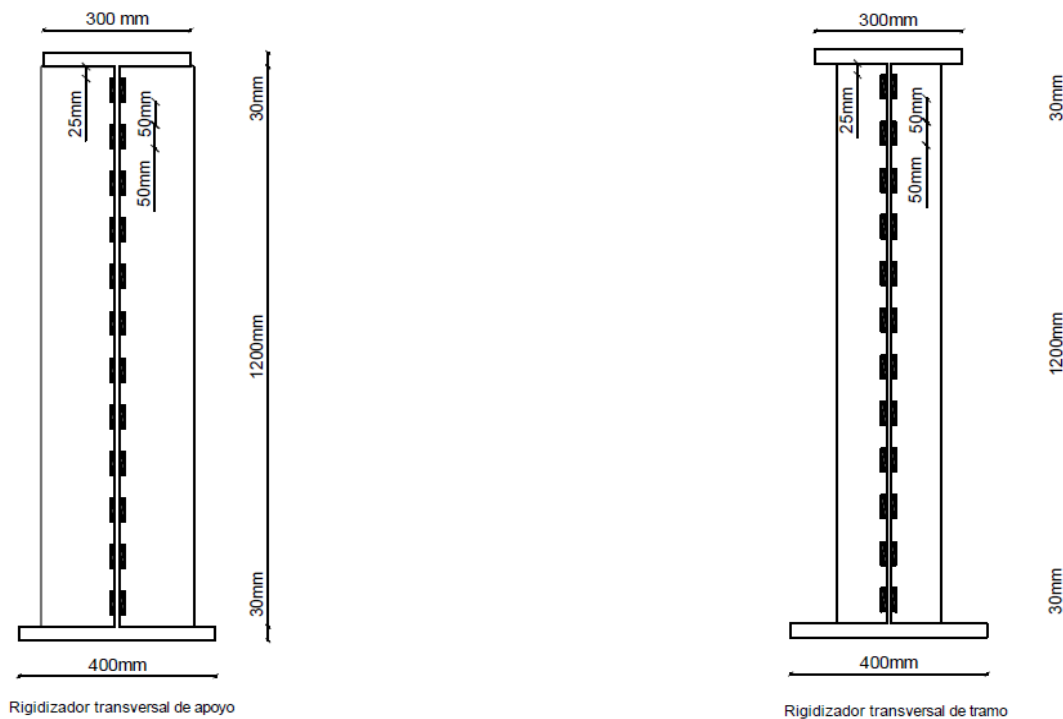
Vista frontal de cordón de soldadura tipo filete unión alma con rigidizadores. Elaborado por: Autor
